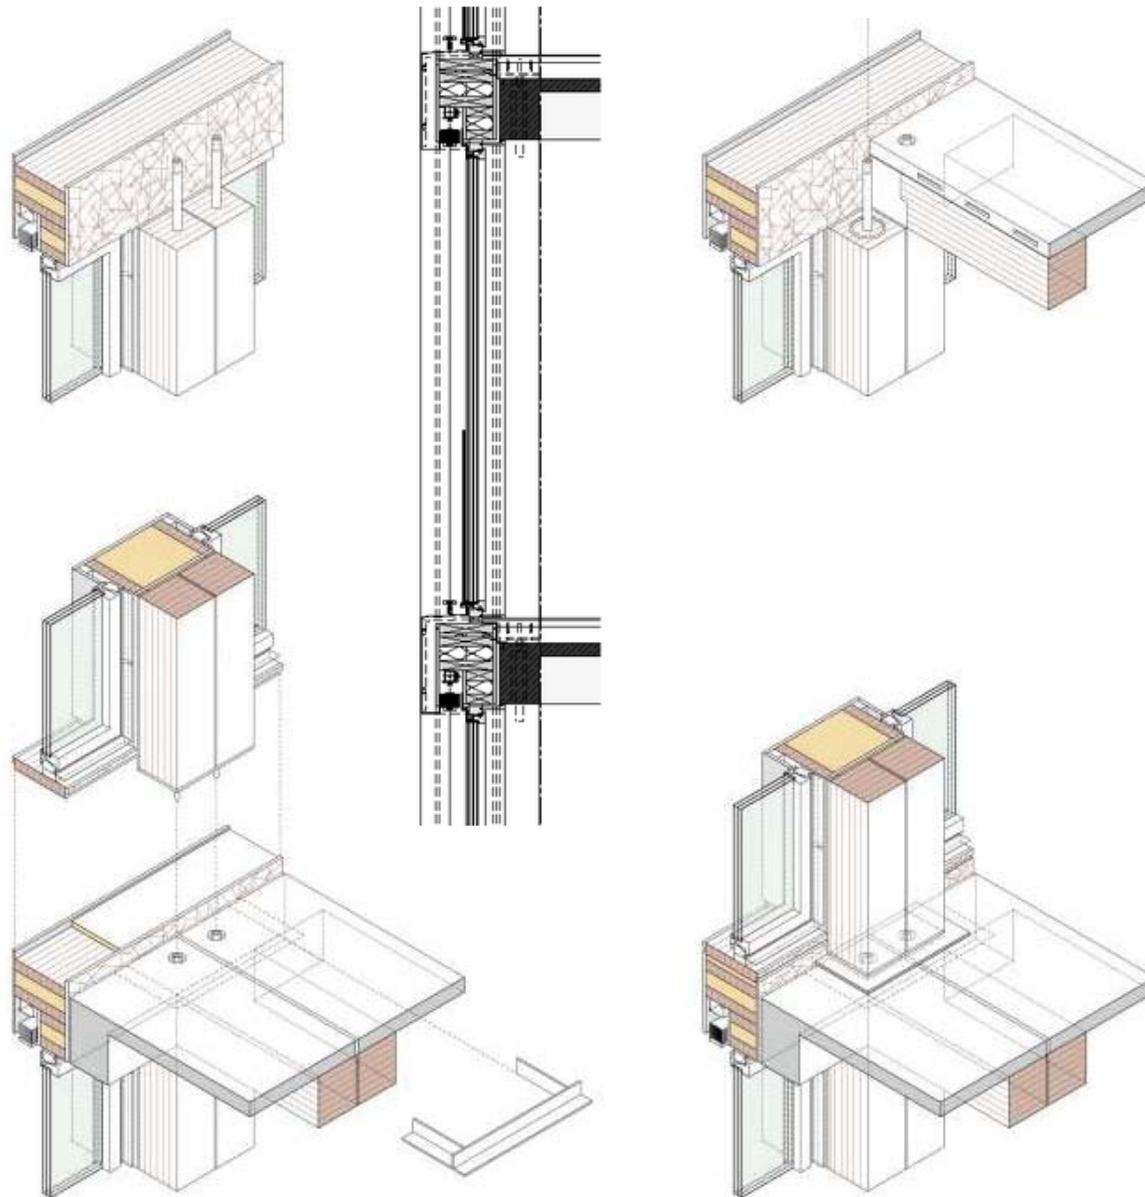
Holzrahmenkonstruktion (Holz-fertigteil-Baukastensystem) mit Doppelstützen und Leimbinder
